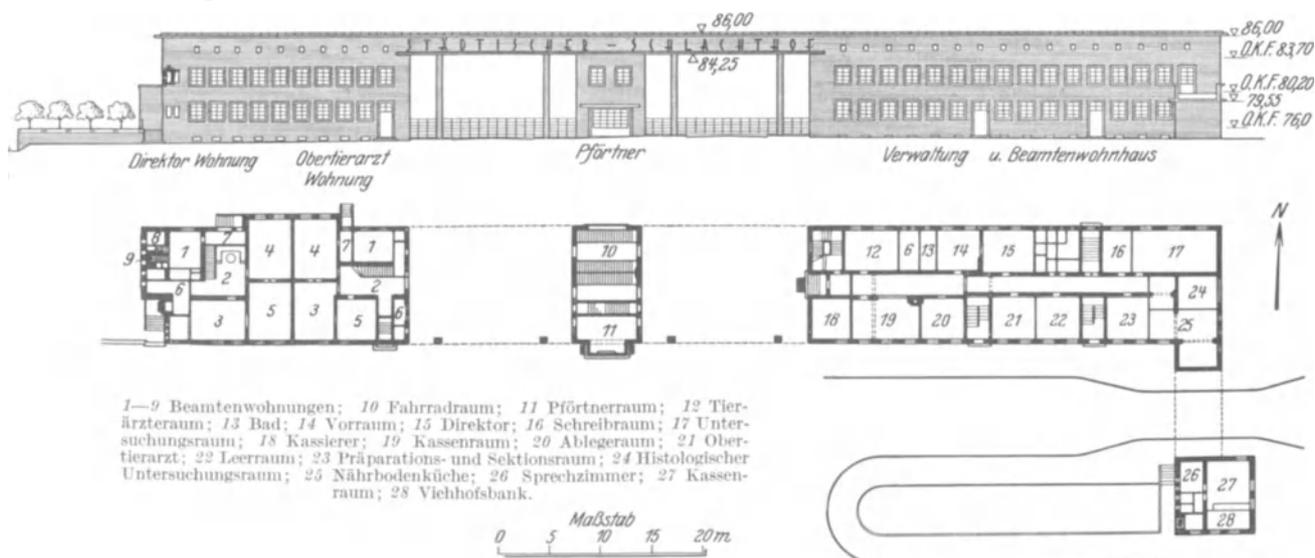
Verwaltungsgebäude einer größeren Anlage (Bochum). Ansicht und Grundriß.
